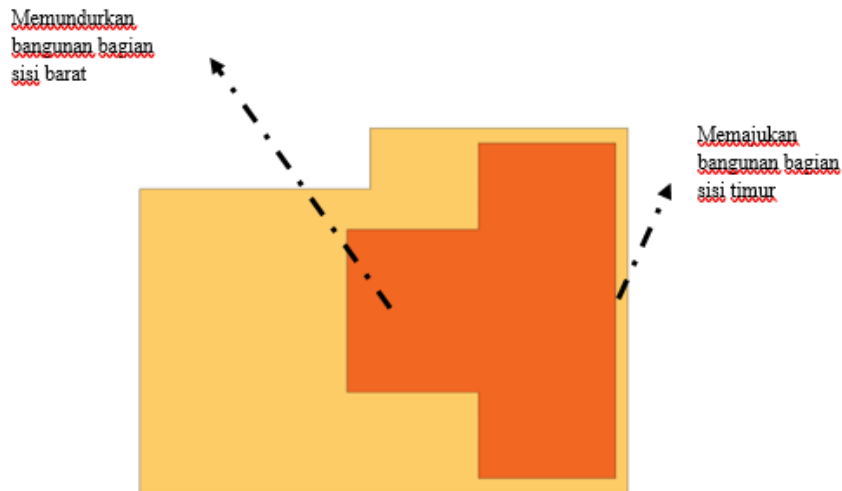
Penerapan Penghawaan Alami pada Bangunan
